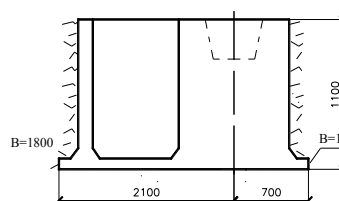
Блочний фундамент з додатковою вертикальною стінкою
